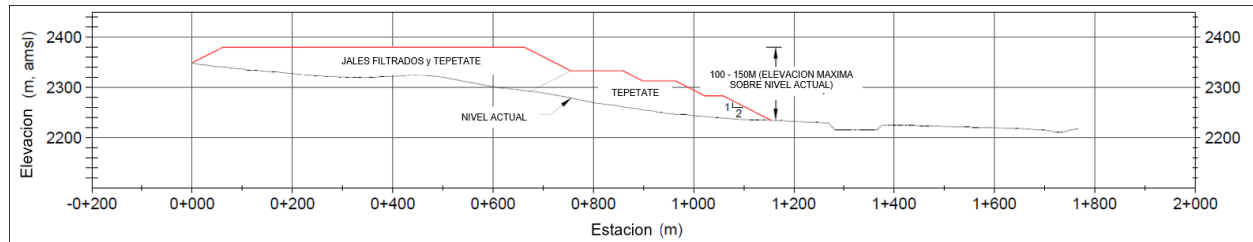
Sección- Porción Sur de la Instalación de Disposición Conjunta de Jales y Tepetate (OesteT/RSF)
